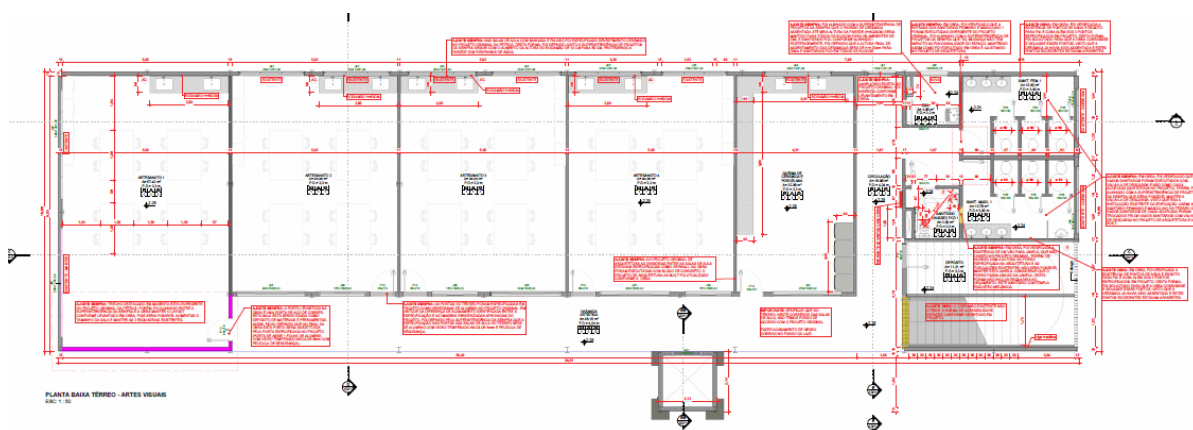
Planta Baixa Térreo – PROJETO AS BUILT
